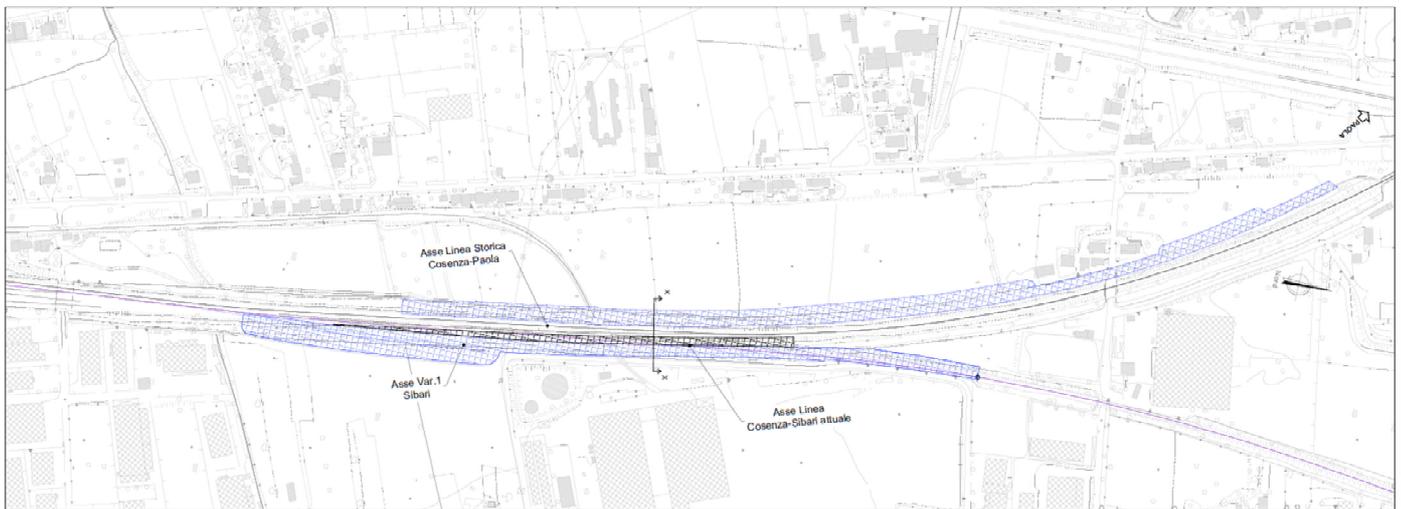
Stralcio planimetrico dell'innesto su C. Cosentino con individuazione della sezione trasversale studiata (X-X)
